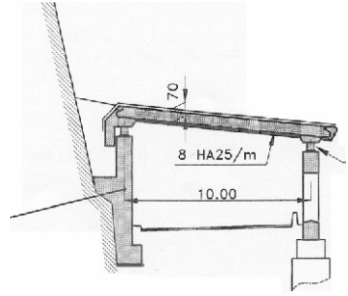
Galerie Pare-bloc Structurellement Dissipantes à dalle horizontale
